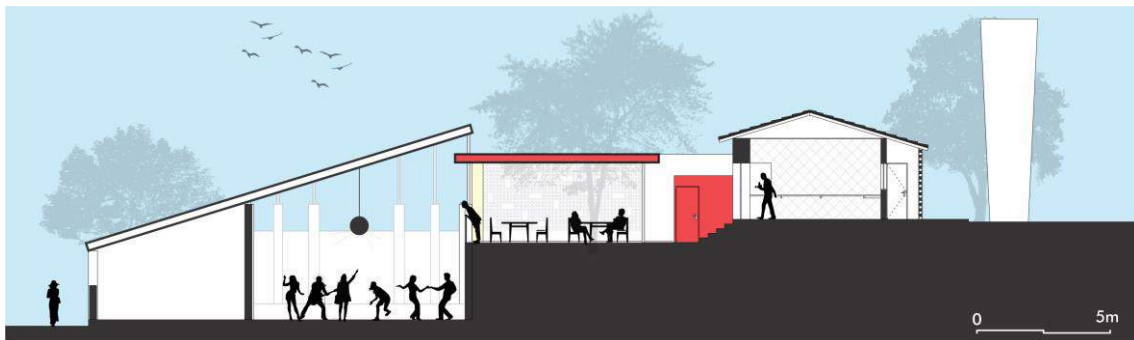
Corte esquemático da proposta final da cobertura restaurante/ espaço de eventos.
